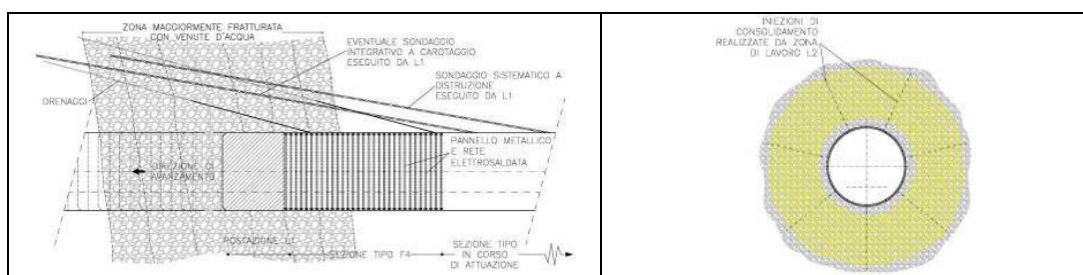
Sezione tipo F5a – Interventi – Profilo longitudinale (a) e sezione trasversale (b)
